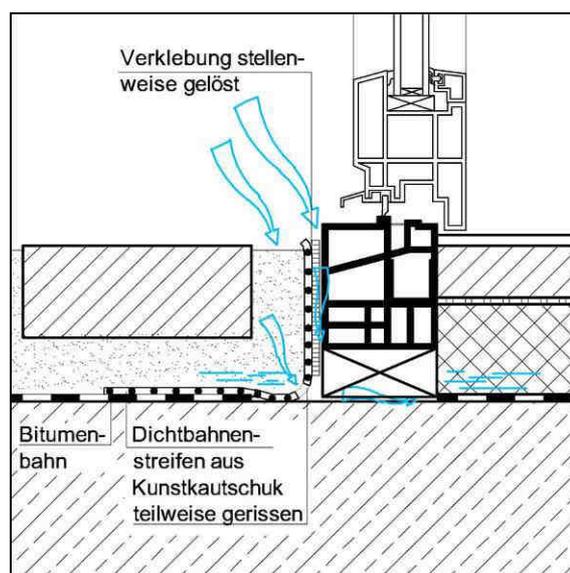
Detail: mangelhafter Abdichtungsanschluss an das Schwellenprofil der Hauseingangstür
